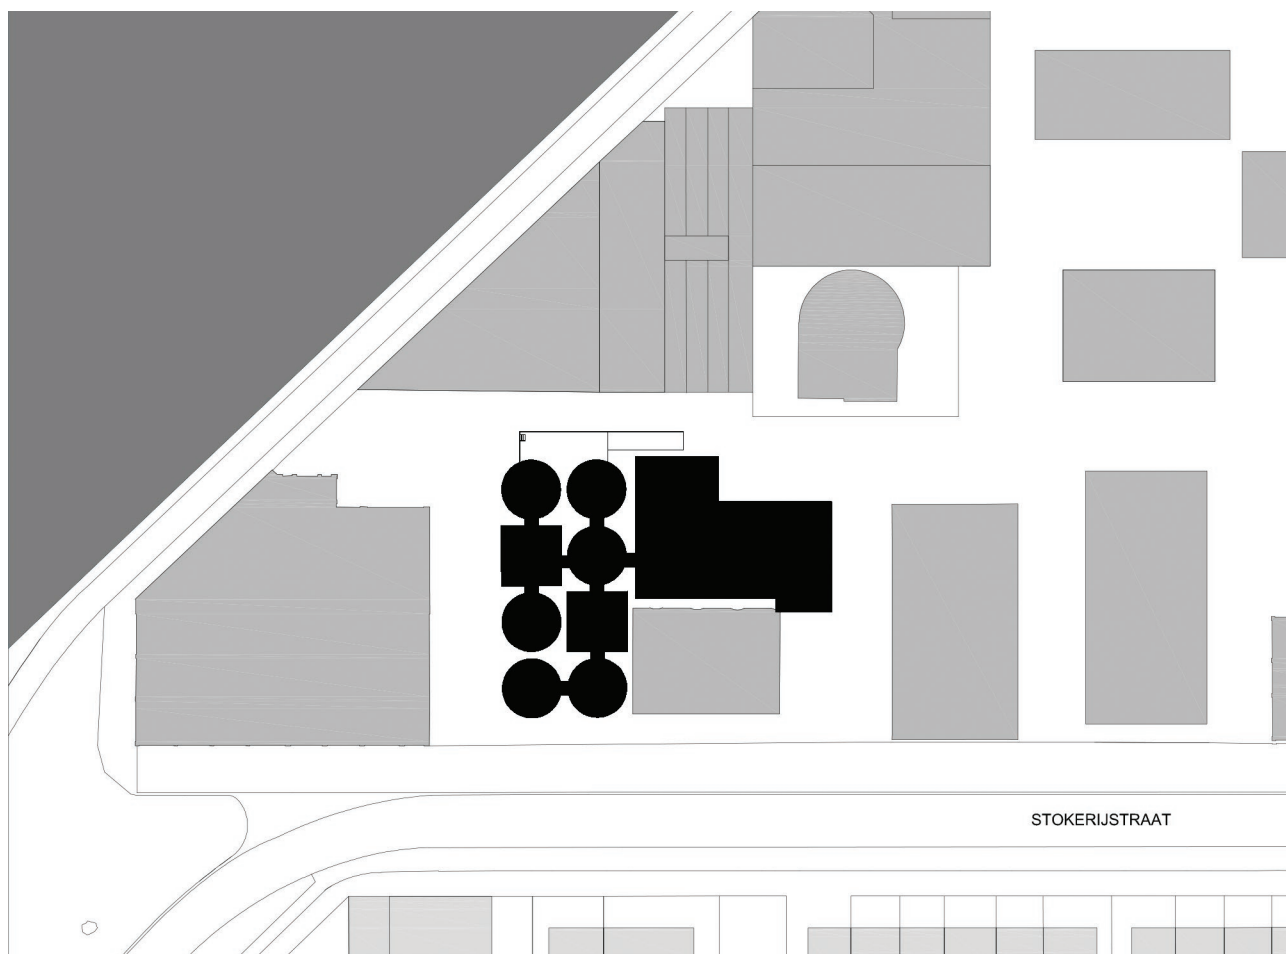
Plan de situation des silos Kanaal : 1/1000
